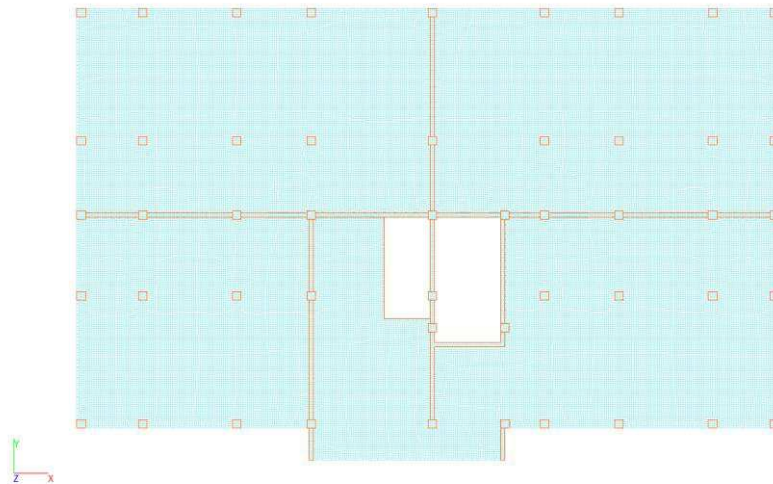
Расчётная схема плиты перекрытия в плоскости
